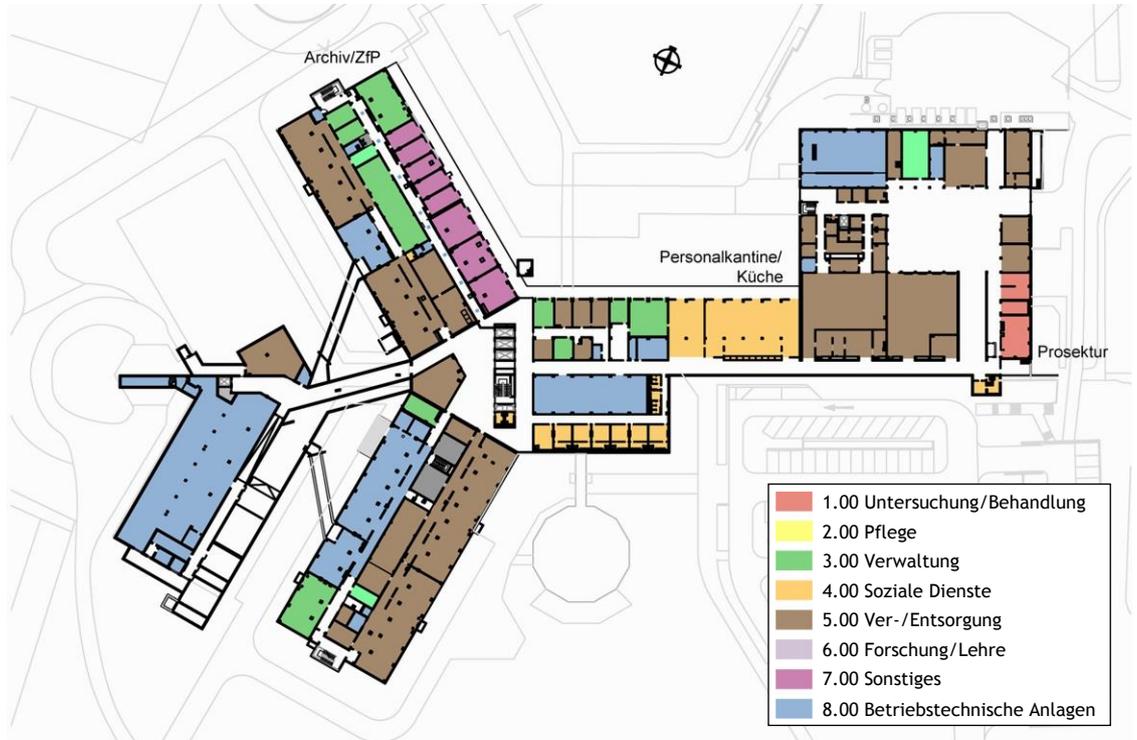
IST-Flächen nach DIN 13080 - 1.Untergeschoss
